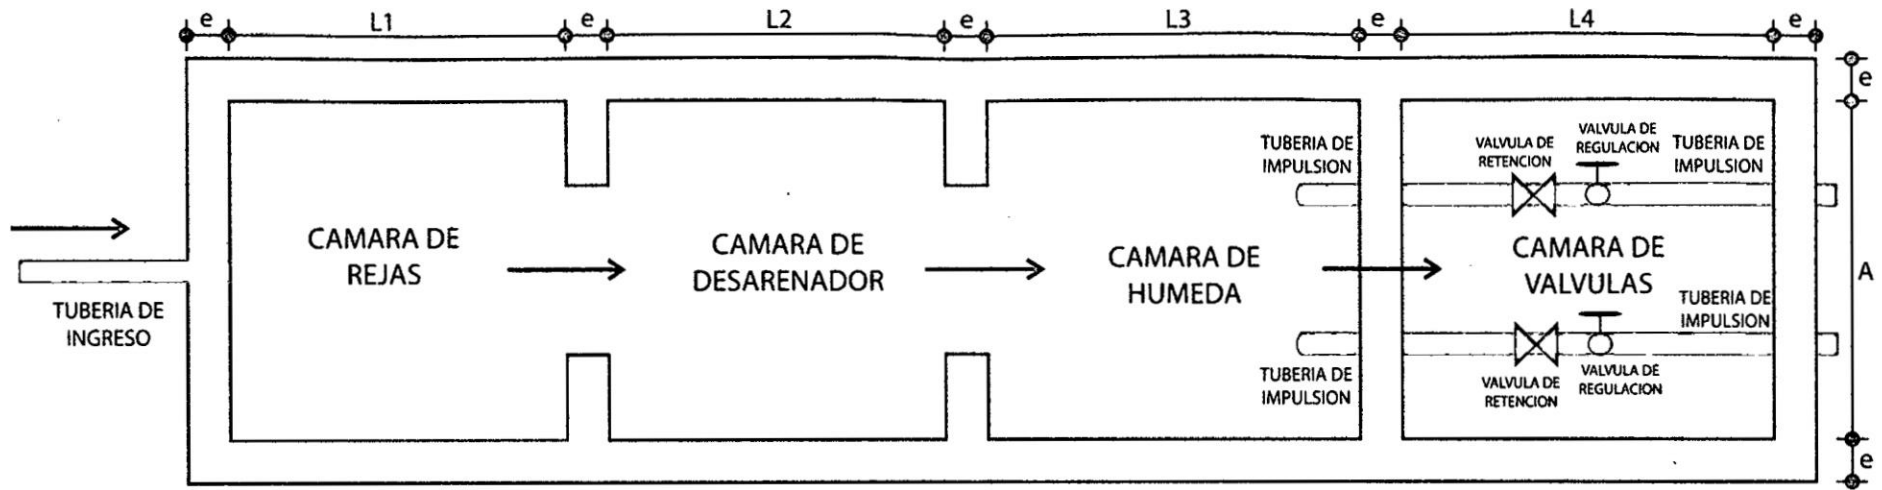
Vista en planta de las estructuras. Fuente: Elaboración propia
